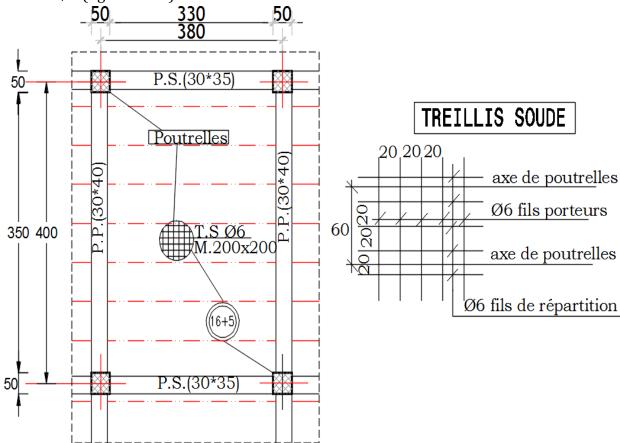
Schéma de ferraillage de La dalle de compression.
